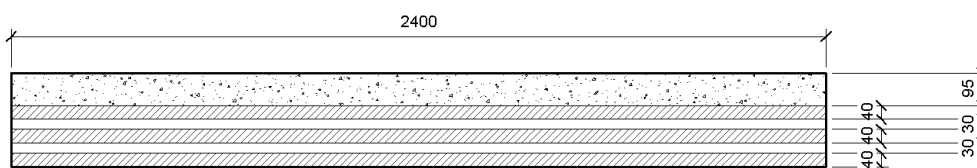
Planvisning dekke 1(Alle dimensjoner i mm)
